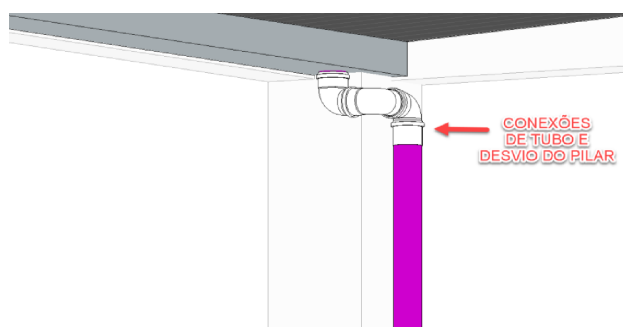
Detalhe da conexão de tubos e desvio do pilar
